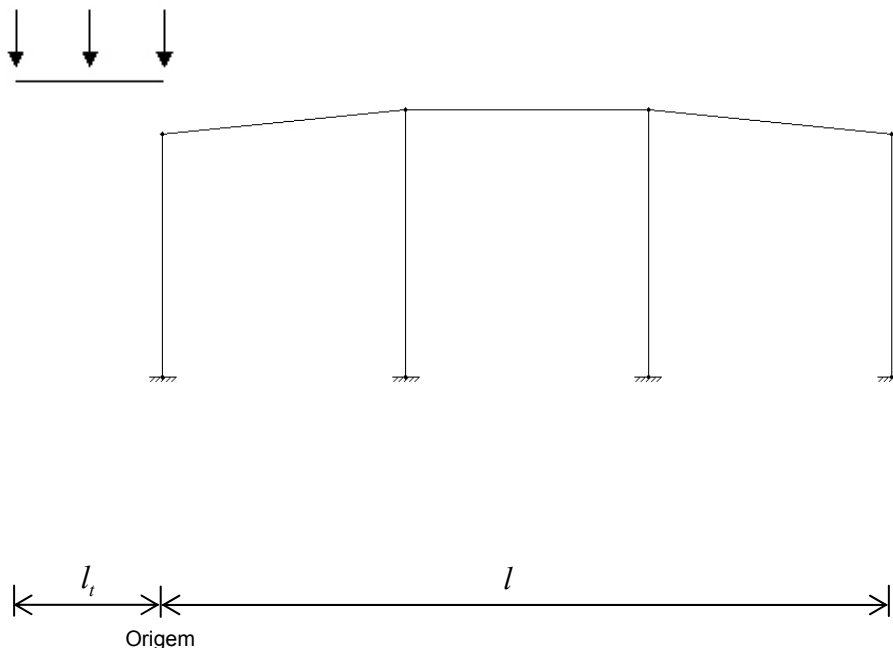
Pórtico com viga inclinada, trem-tipo e espaço de busca.
